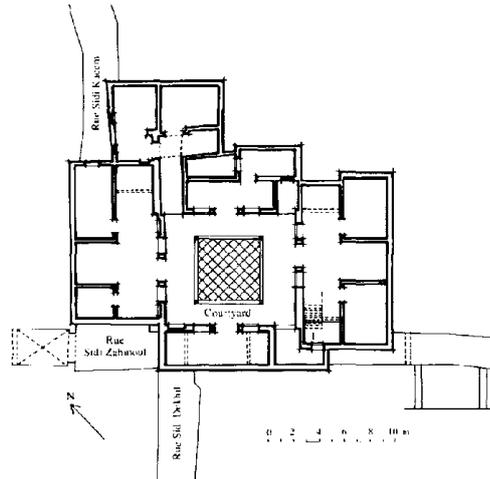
Bangunan tinggi lantai bawah sebagai aliran angin
